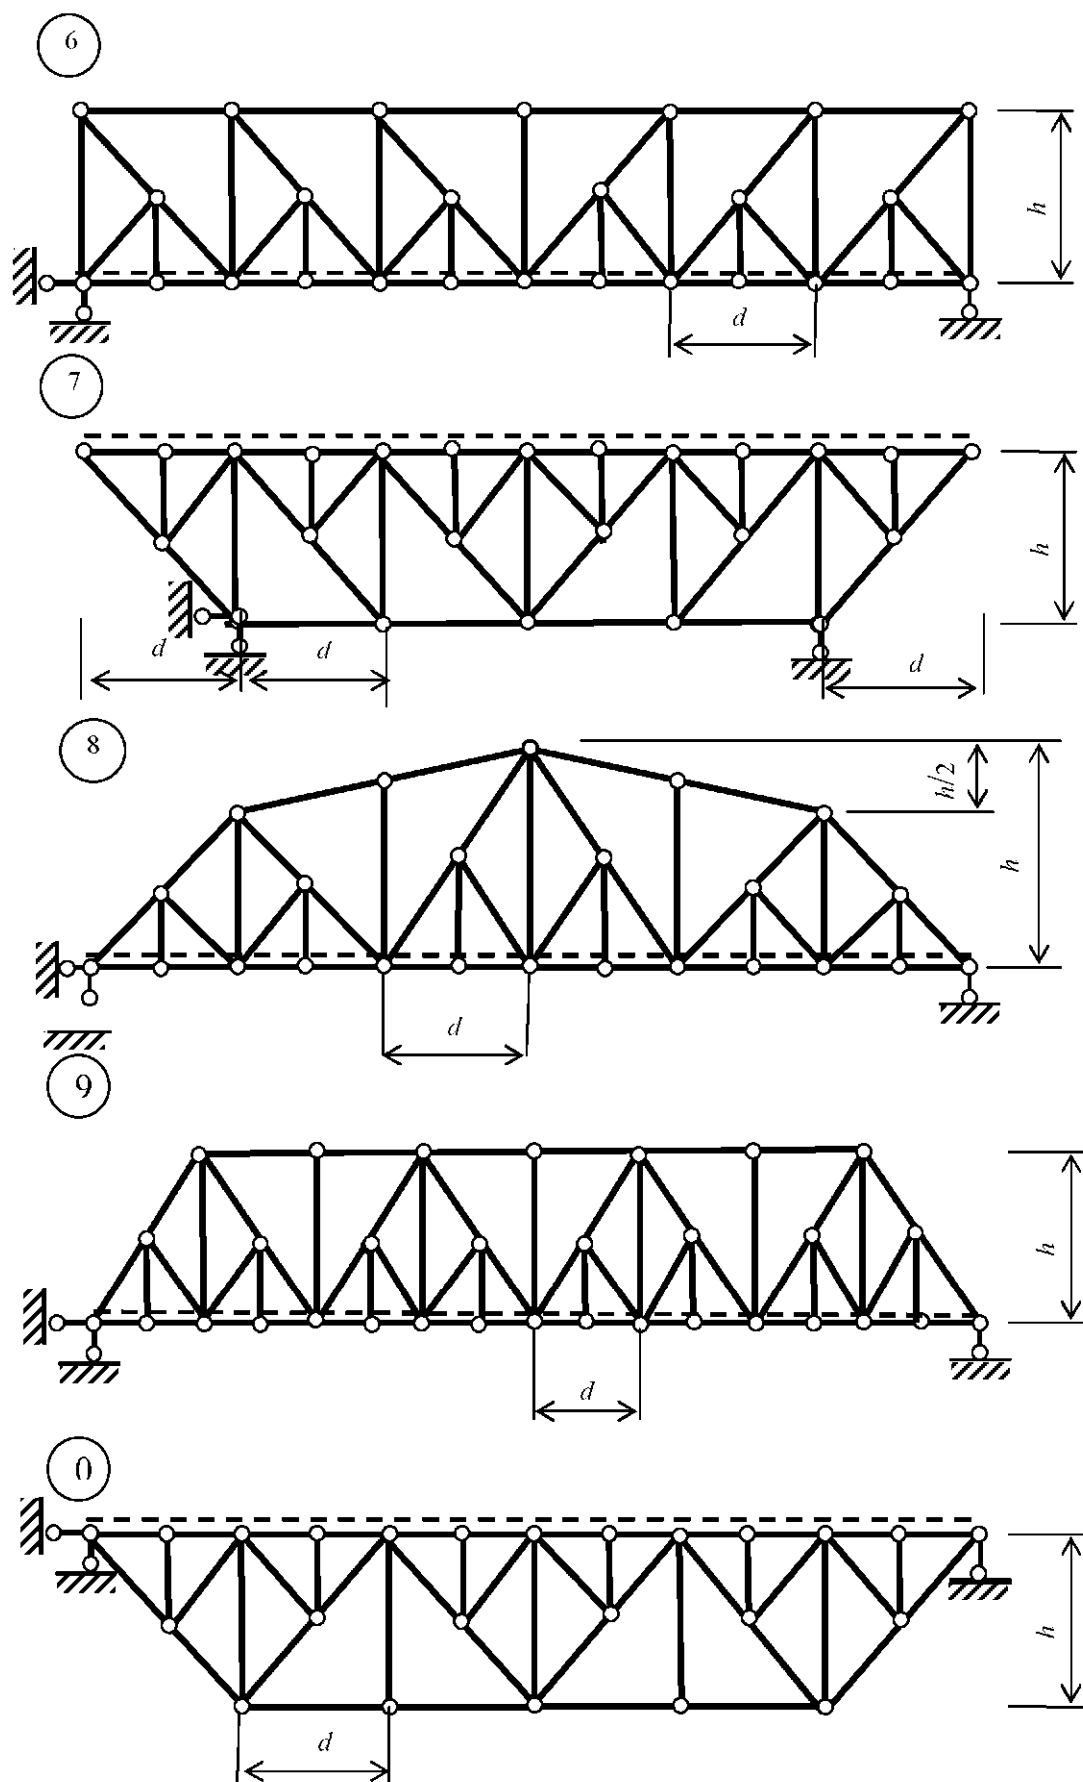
(окончание). Расчетные схемы 6-0 шпренгельных ферм
